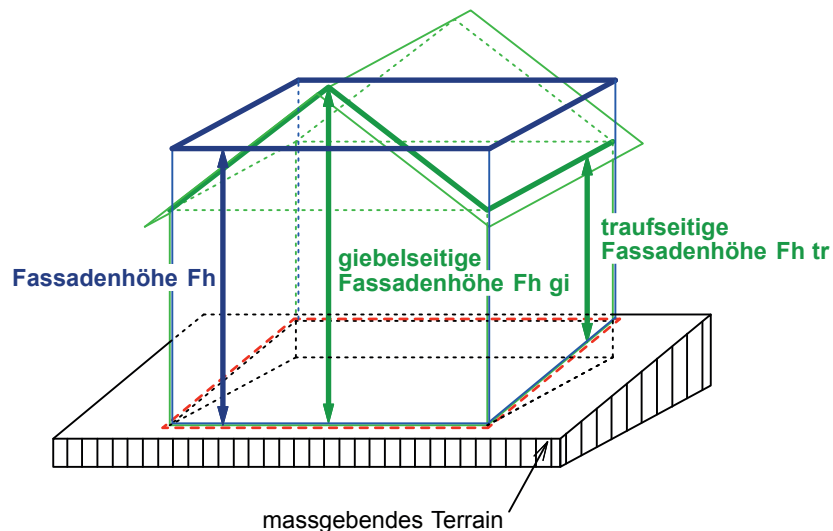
Skizze Fassadenhöhe gi/Fassadenhöhe tr und Fassadenhöhe
